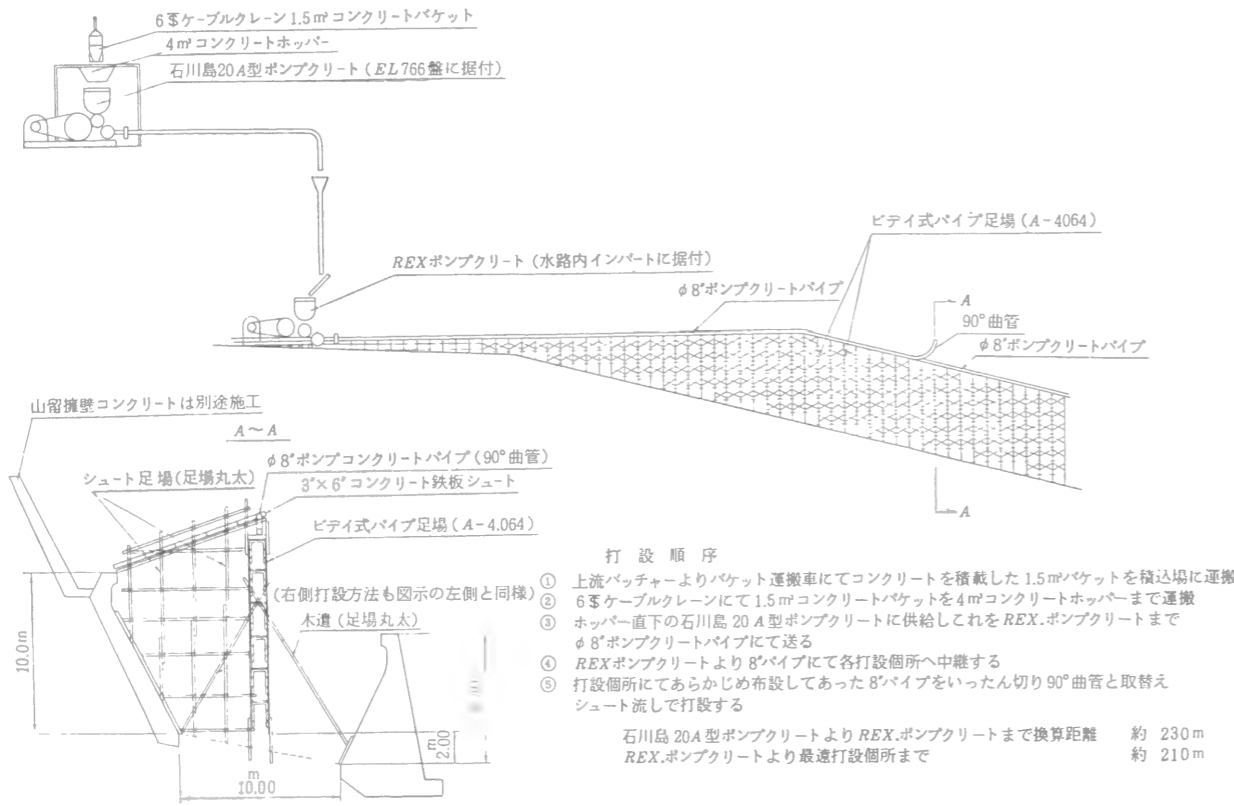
コンクリートシュート部打設図(御母衣ダム)
